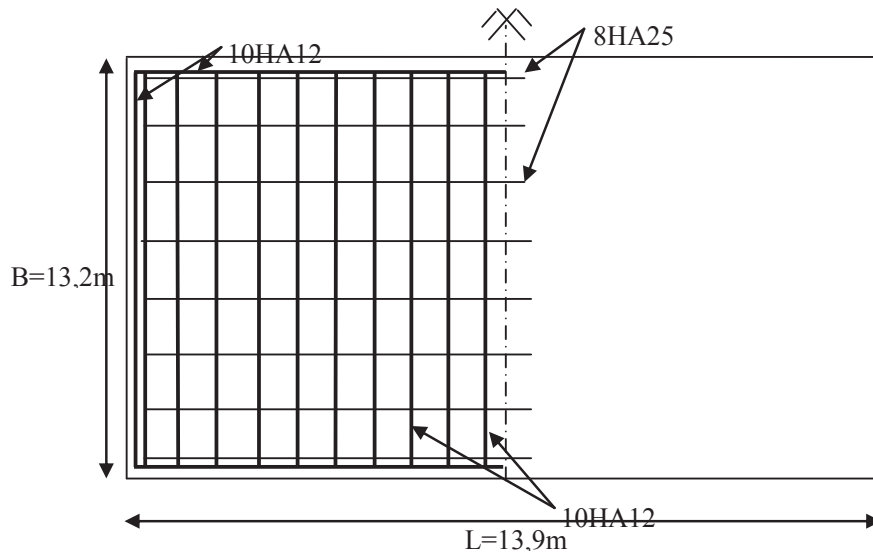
Ferrailage de la semelle (Nappe supérieure).
